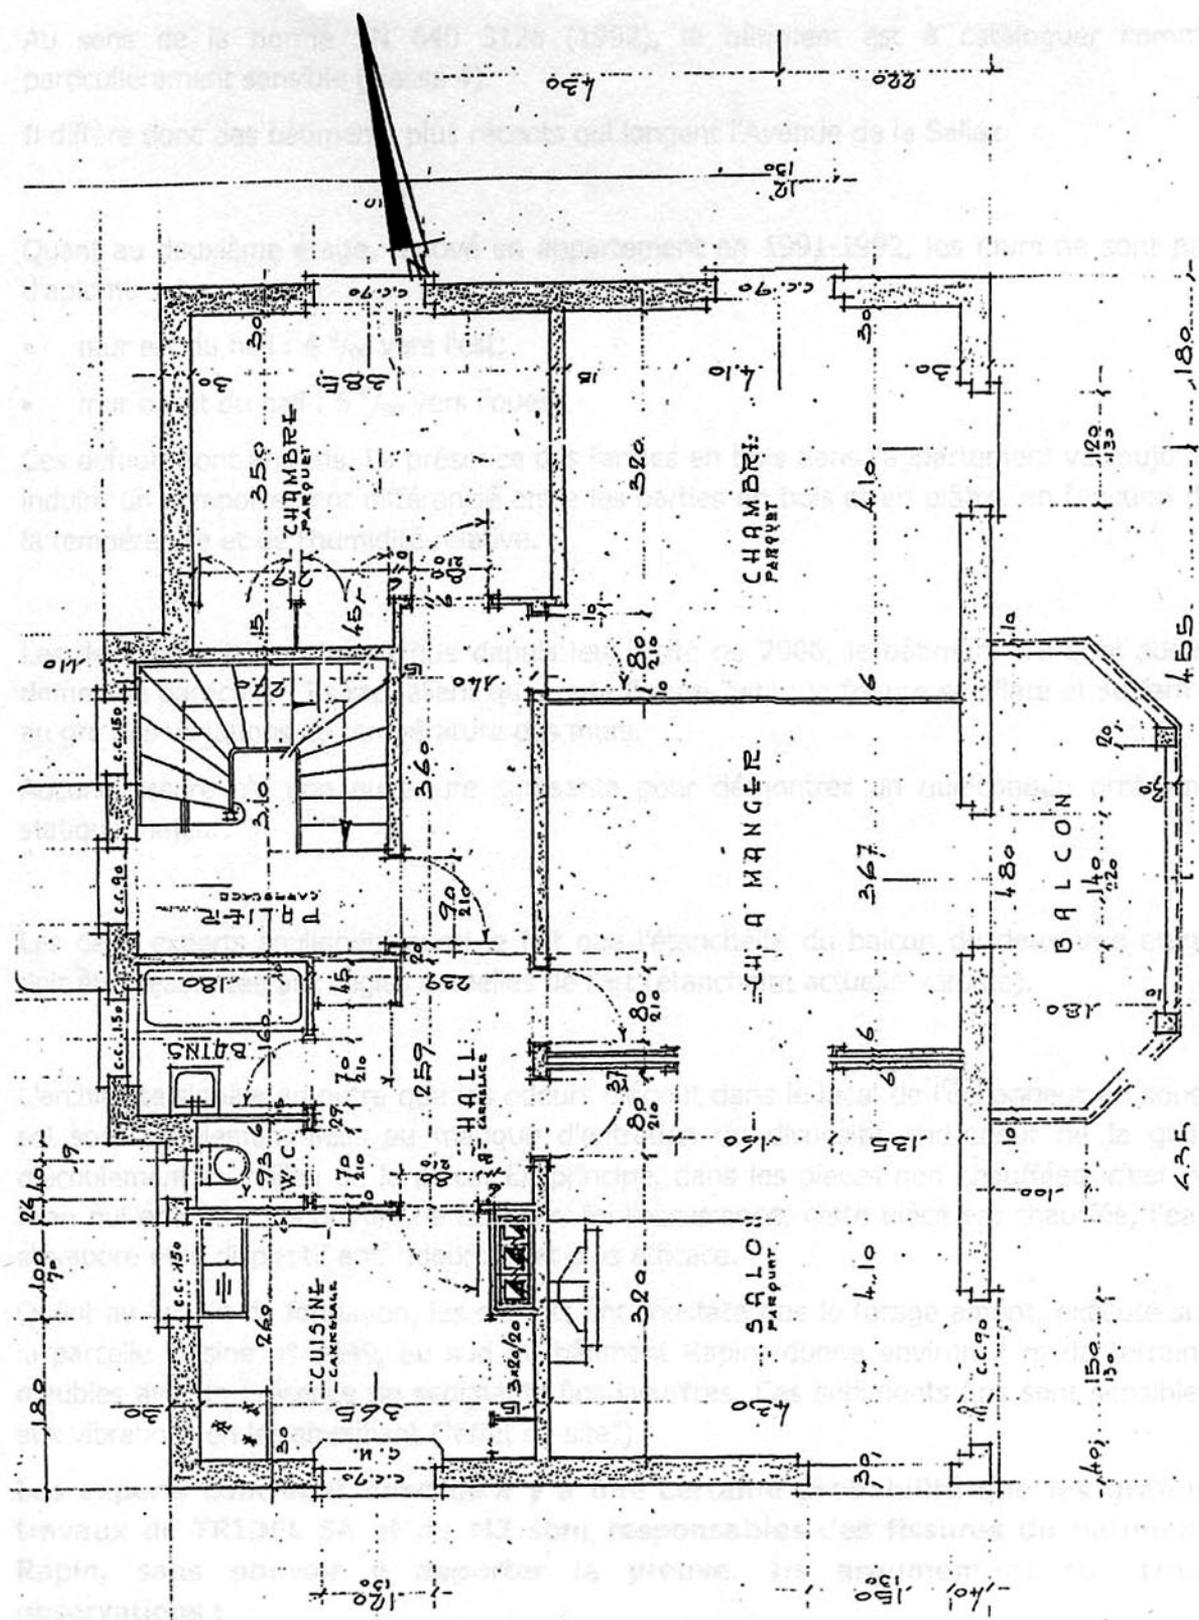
Plan du rez-de-chaussée et du premier étage du bâtiment Rapin, à Lausanne
